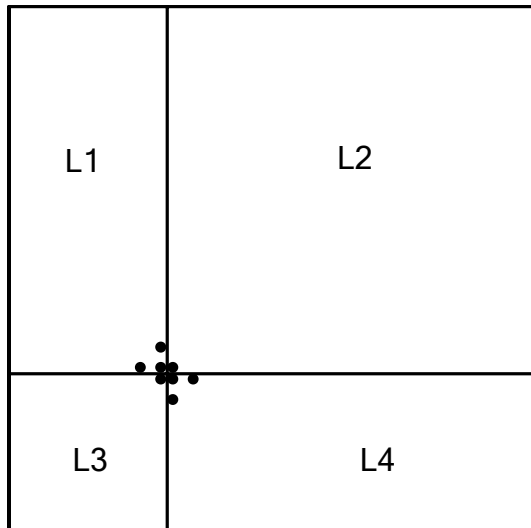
Pontos fissurados na face superior do pavimento para a carga quase permanente
